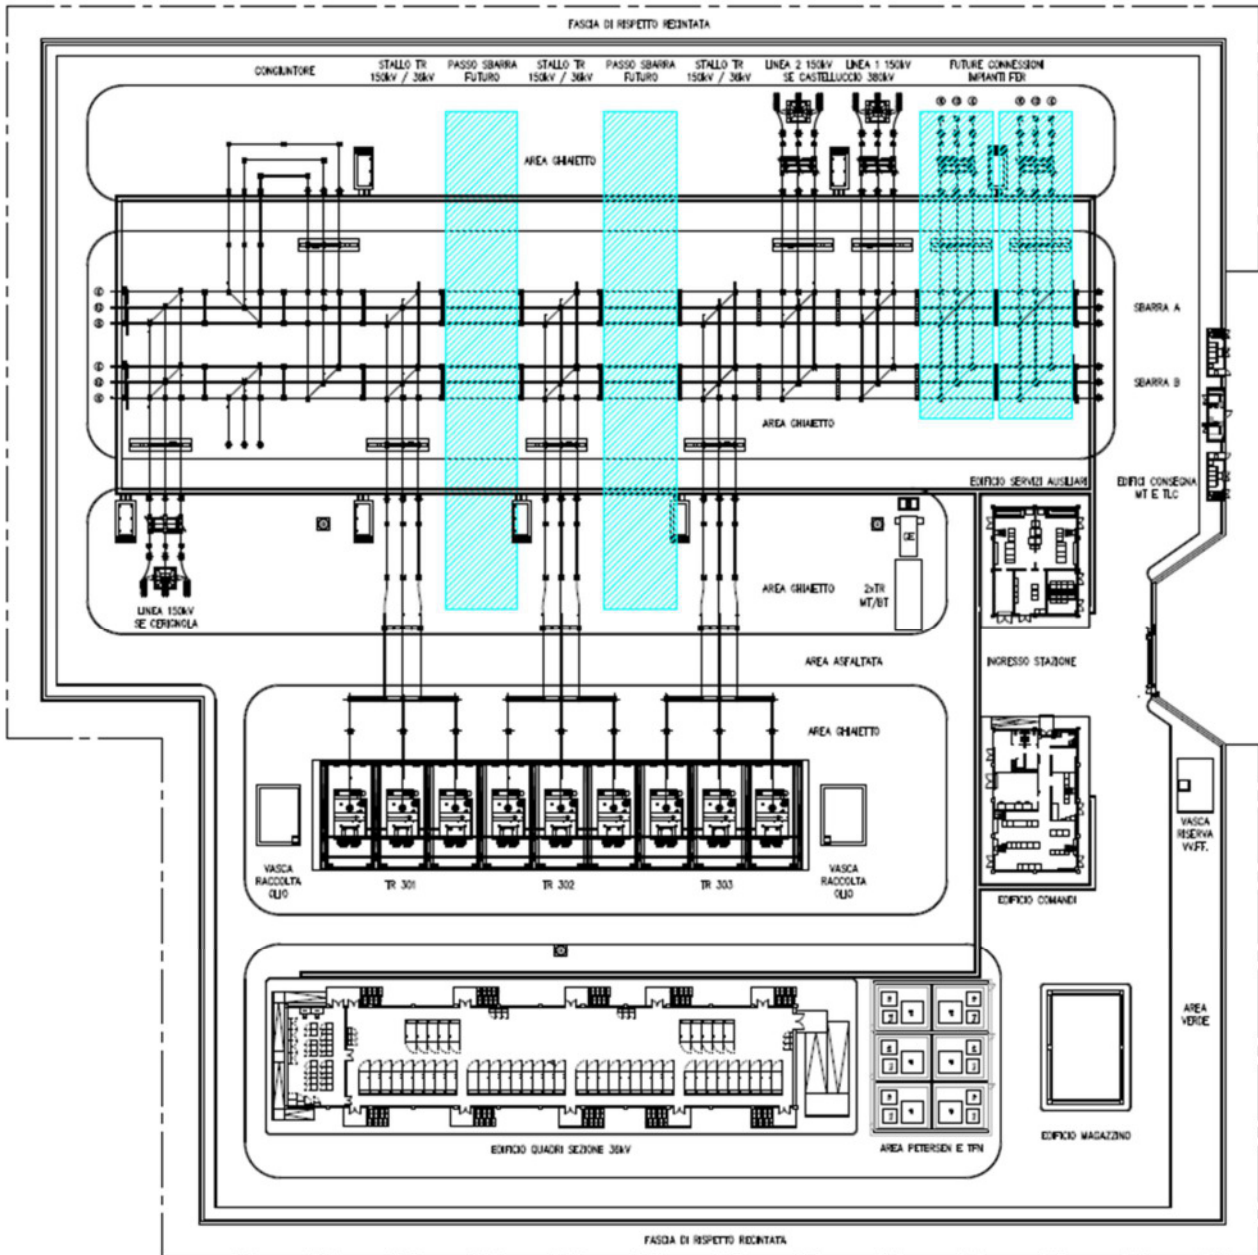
Layout della stazione elettrica 150/36 kV sita in Castelluccio dei Sauri
